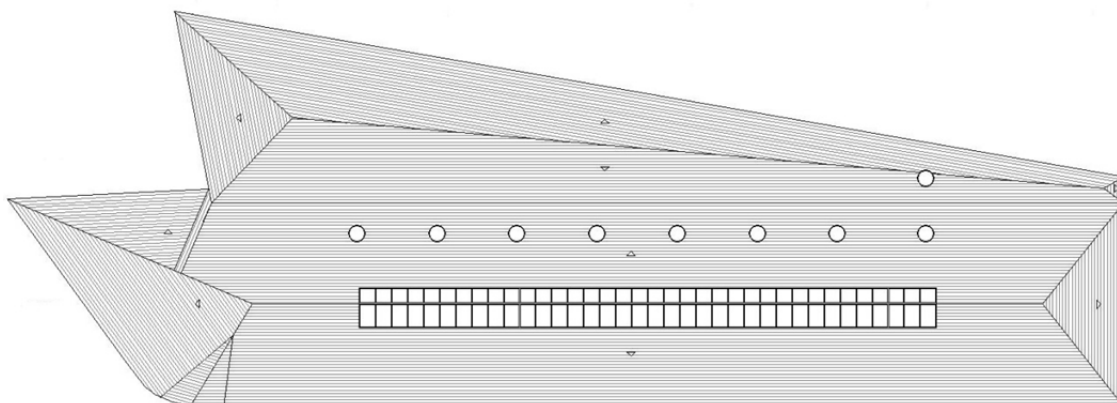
Planta de Cobertura do Projecto de Reabilitação
